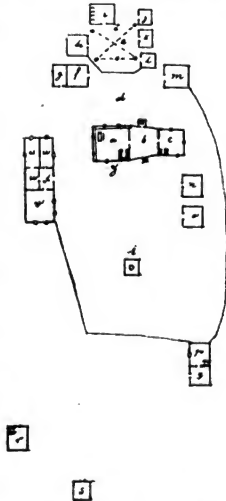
Grundriss eines sawolaksischen Bauerhofes. Jäppilä. St. Michel.
